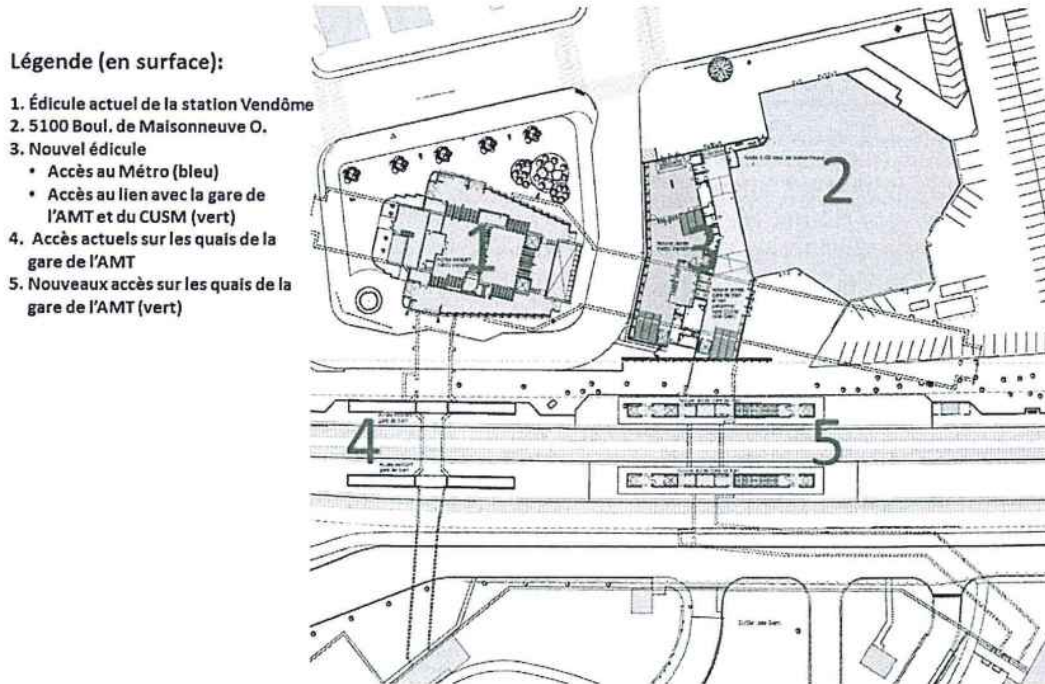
Plan du projet au niveau du rez-de-chaussée
